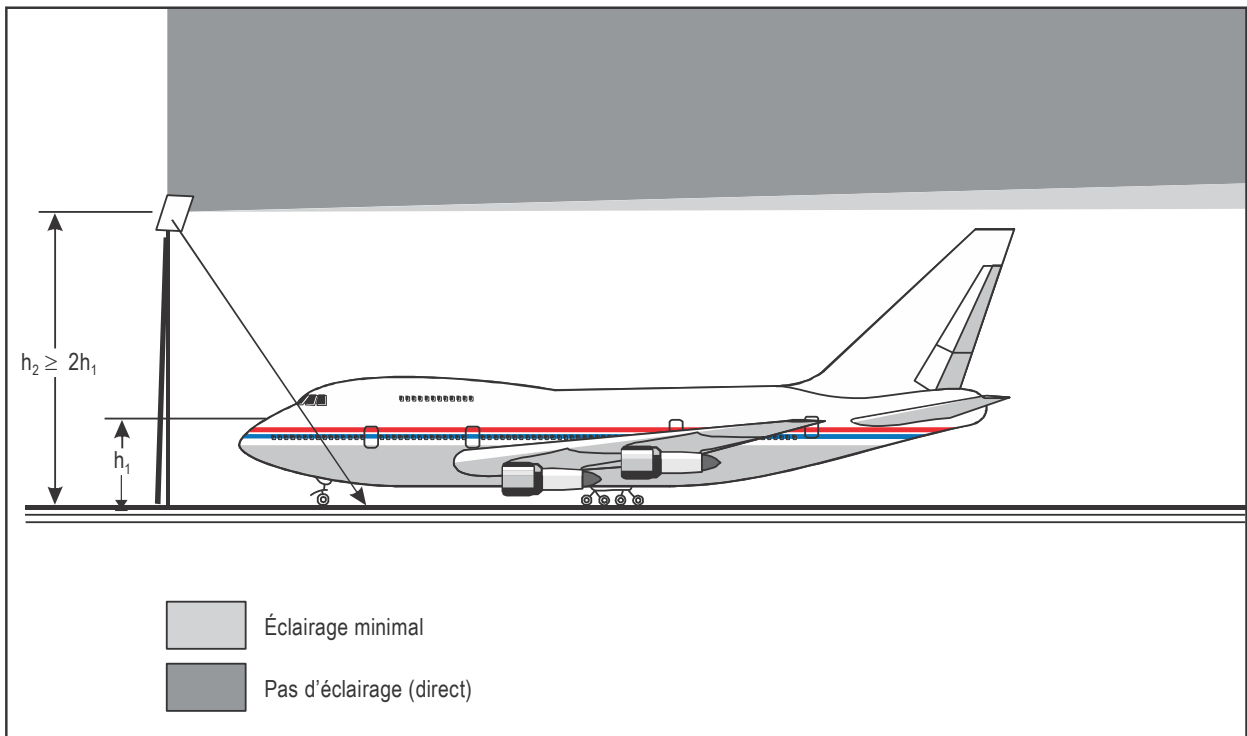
Hauteur de montage permettant d'éviter l'éblouissement
